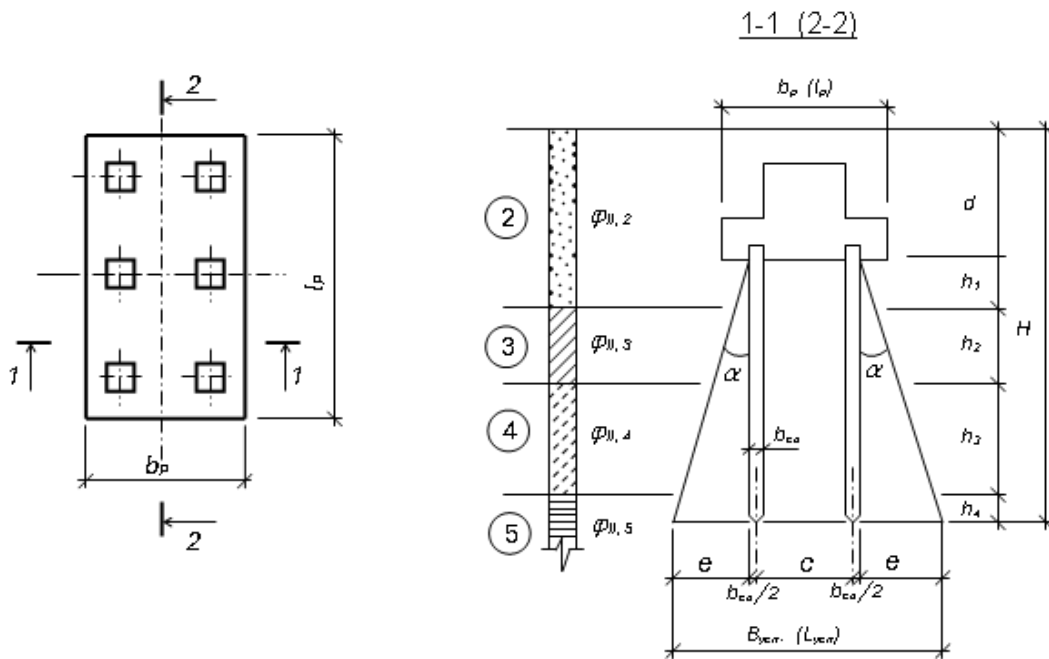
Схема розрахунку умовної ширини (довжини) підосви пального фундаменту
